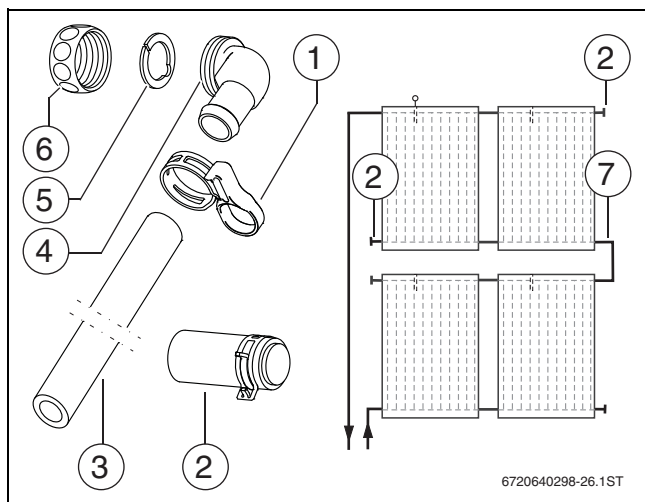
Zasilanie z odpowietrznikiem ponad dachem
